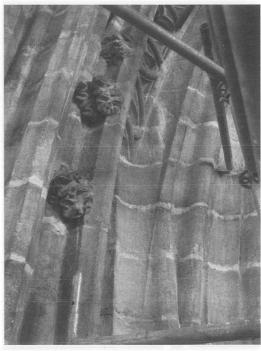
Inicio caireles de la bóveda. Paramento norte (foto de los autores)
